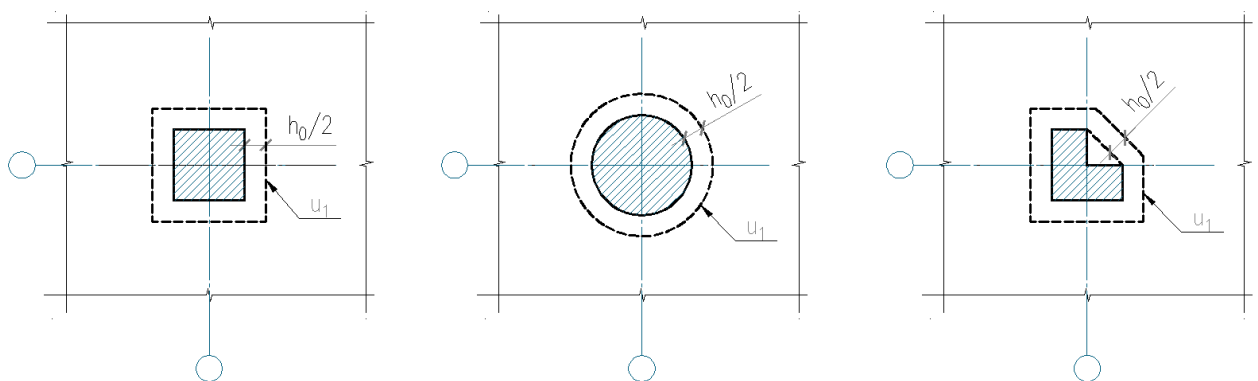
Расчетный периметр с колоннами разных сечений.
